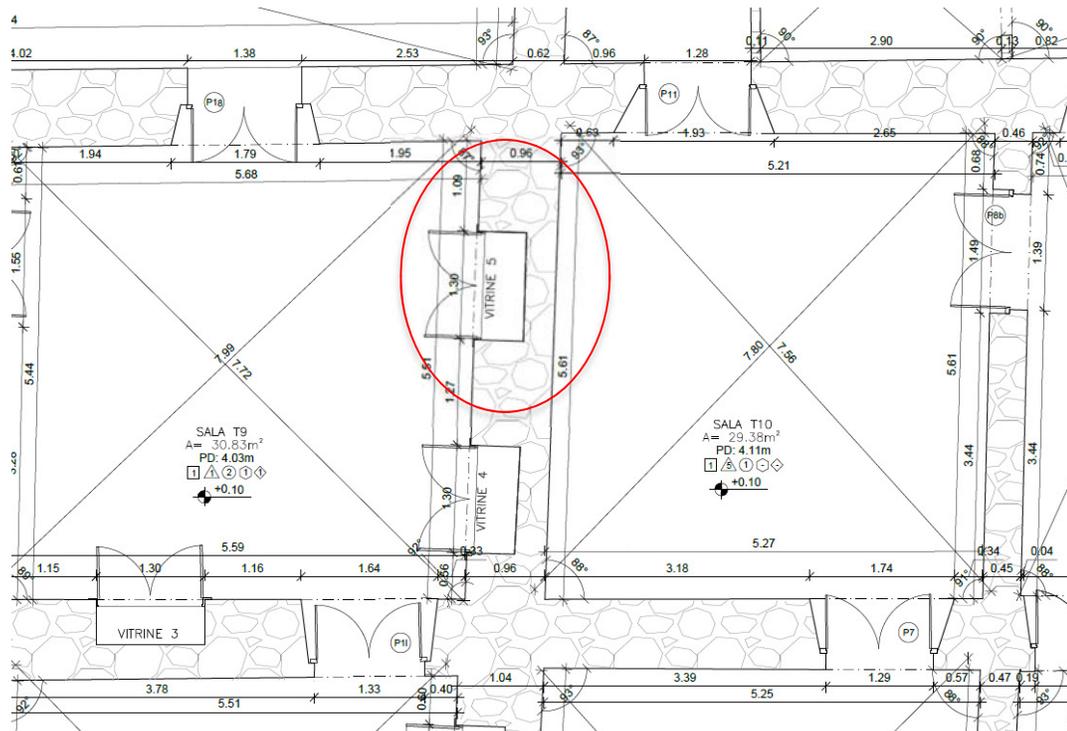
Planta com local de fissura, mostrando o rebaixo da alvenaria.
